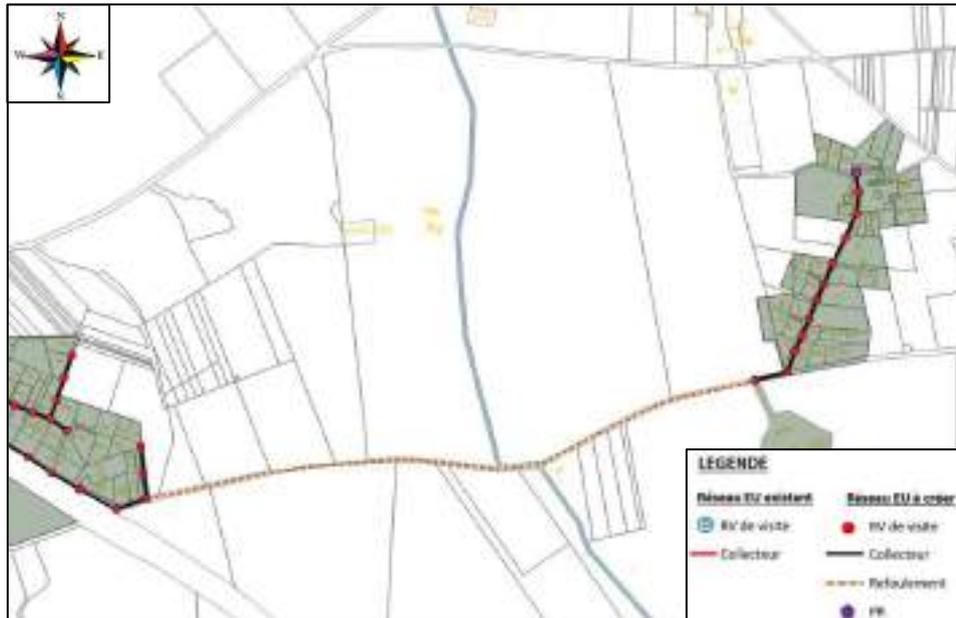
Tracé potentiel du raccordement du hameau de Danis
